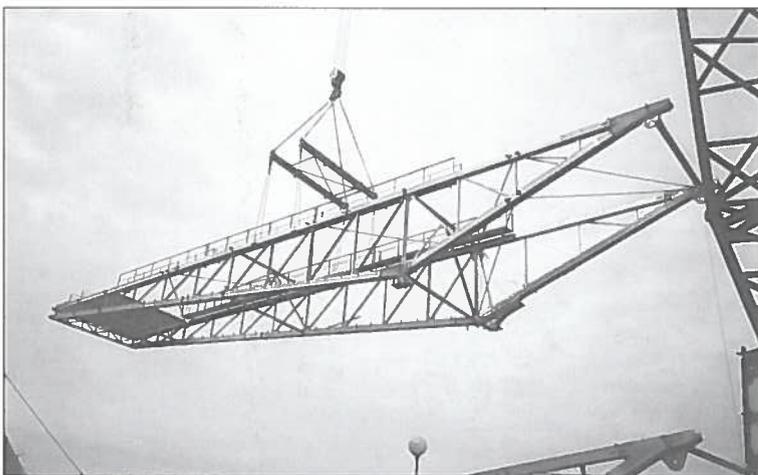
Fase di montaggio di un modulo della struttura di copertura.
